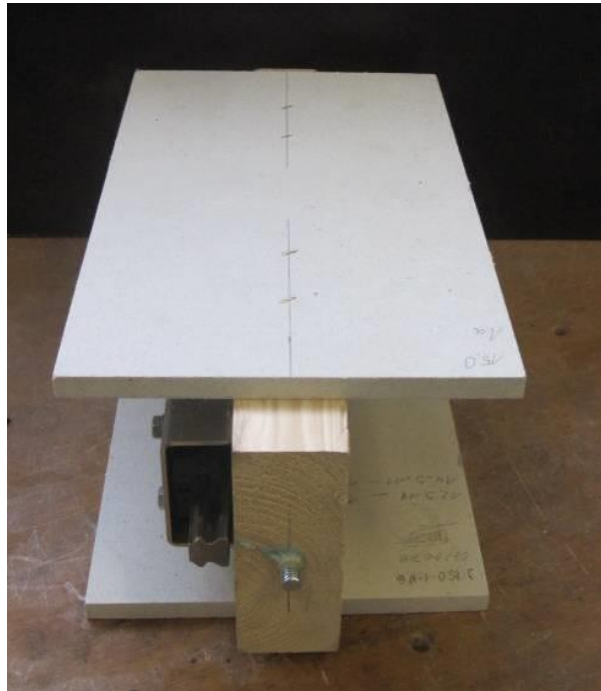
Scherkörper mit Linearführung; Ansicht
